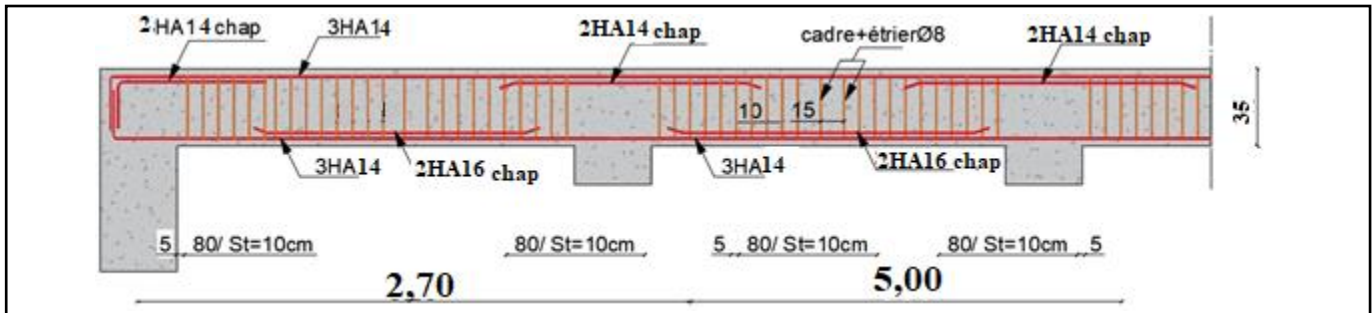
Coupe longitudinale de la poutre principale(chainage).
